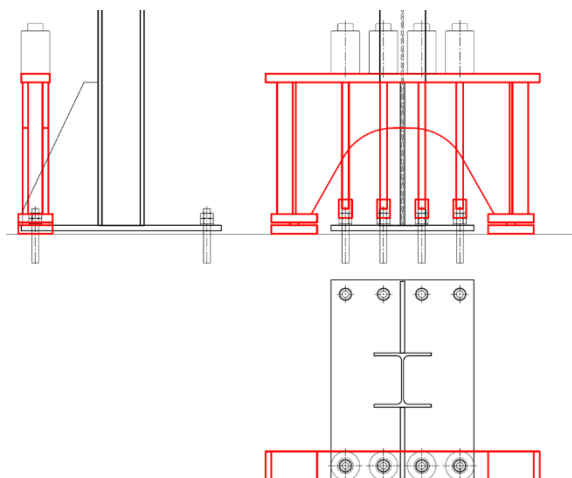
Schema della prova di estrazione con cavalletto di contrasto
